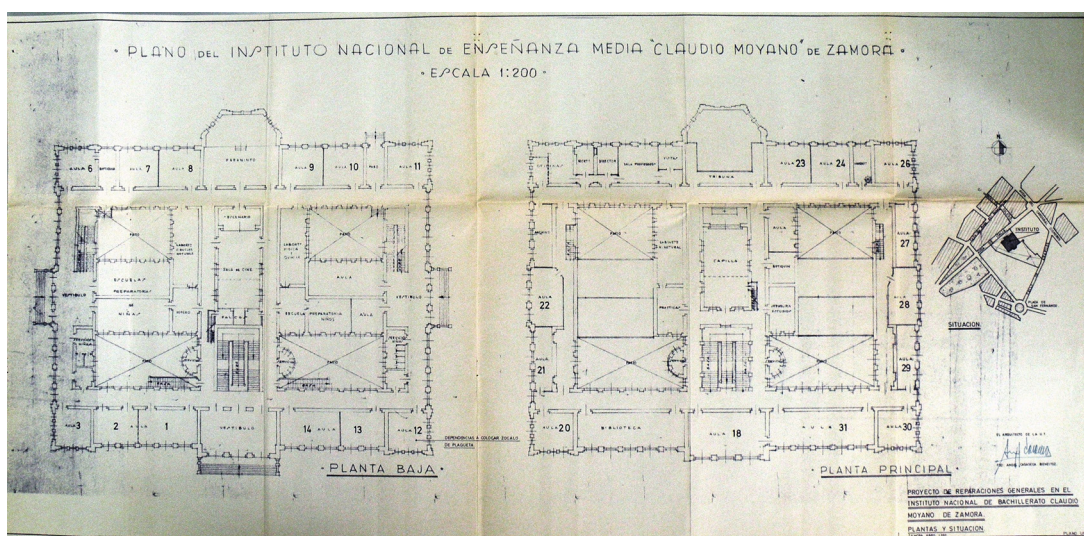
Copia del plano de plantas baja y principal. AMZa.OyU.OM/140/83.
